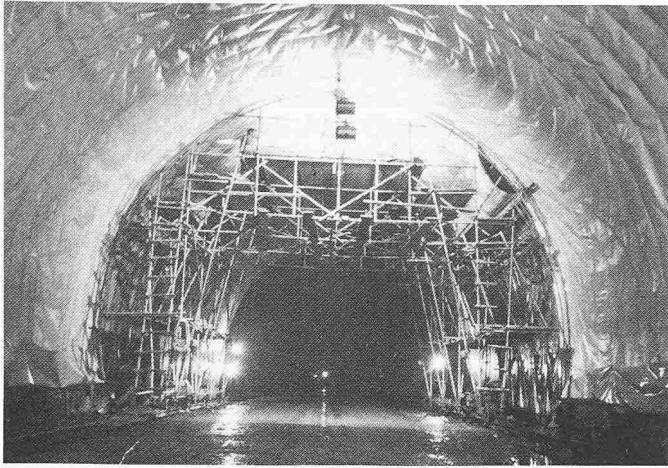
Mit PVC-Folie ausgekleideter Tunnel. Ausserdem sieht man das Rollgerüst, von dem aus die Folien befestigt werden
